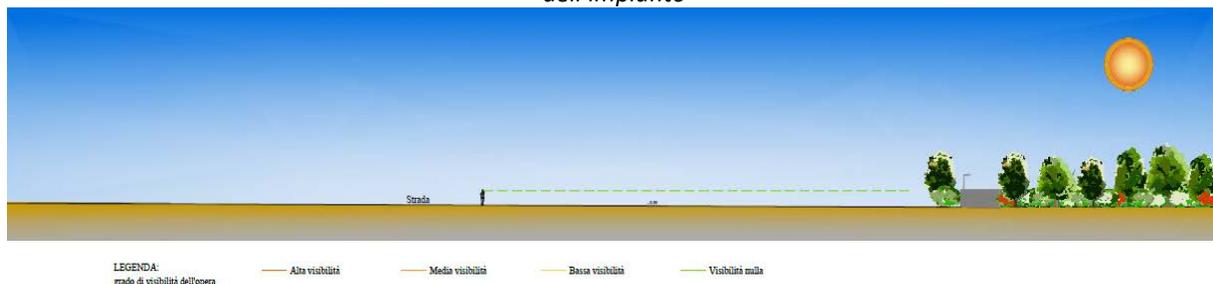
Sezione di intervistibilità dal punto di vista chiave n. 1 dalla strada del Piano Particolareggiato dell'“AIA” verso l’area dell’impianto
